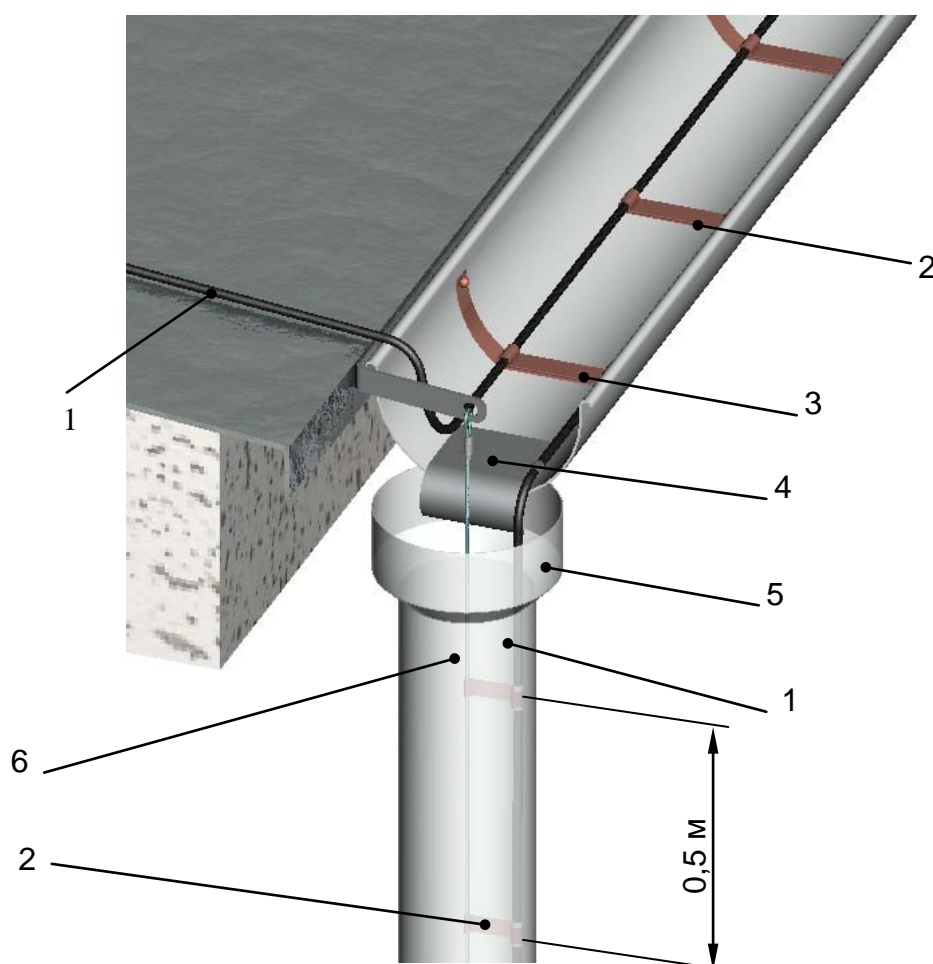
Крепление одной нитки нагревательного кабеля в водосточной трубе с переходом на лоток. Водосточная труба является оконечной в системе лоток-труба. Поддерживающий трос крепится к элементу конструкции кровли. Накладка исключает излом кабеля в месте его перехода из лотка в водосточную трубу.
